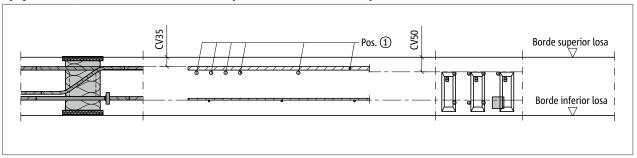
Schöck Isokorb® XT tipo C: Armadura in situ esquinero externo (sección XT tipo C-L-CV35, vista XT tipo C-R-CV50)
